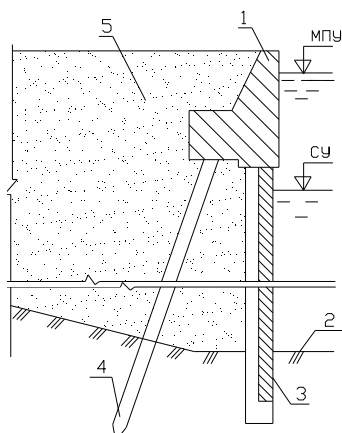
Стена из железобетонного таврового или прямоугольного шпунта с наклонными анкерующими сваями:
